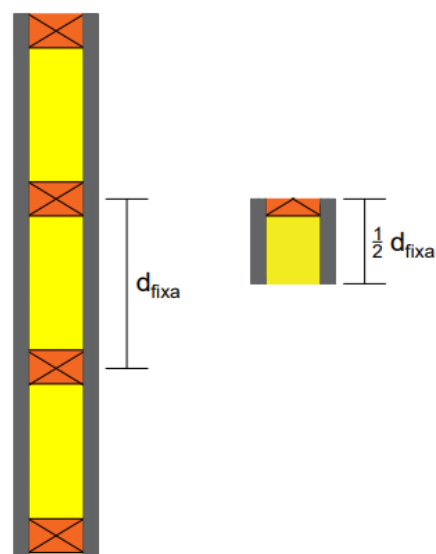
Modelo geométrico para pormenores construtivos quando existe plano de simetria (Adaptado de ITecons, 2011a).
